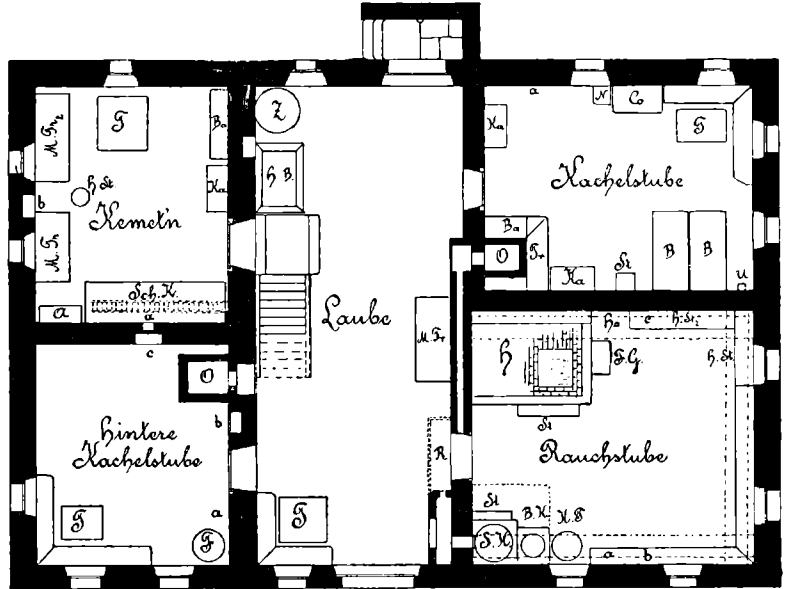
Grundriss des Erdgeschosses des Hatz-Hauses.
